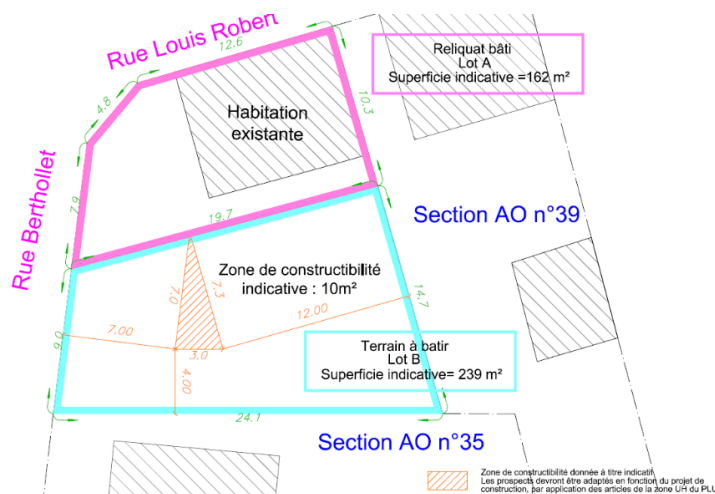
Plan projet avec la zone de constructibilité maximale, PLU 2019 et 2022
